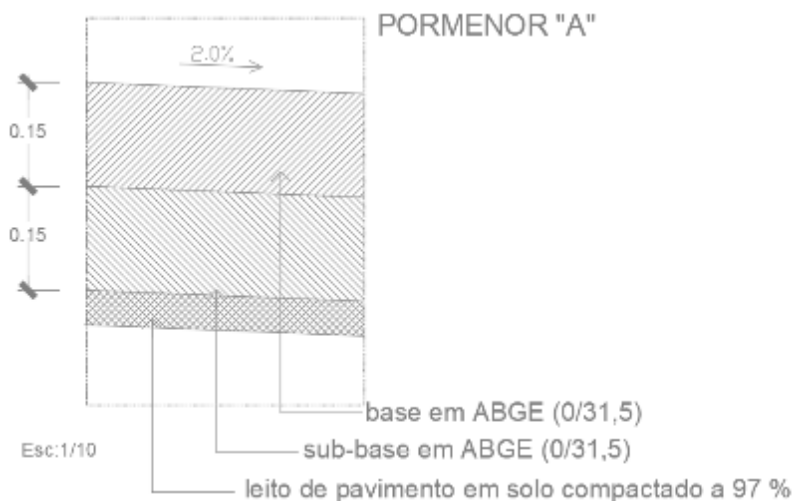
Corte tipo geral do pavimento em ABGE
